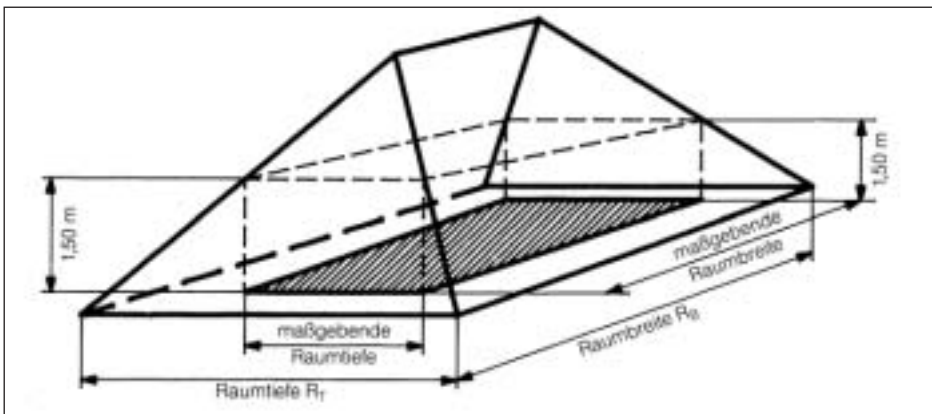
= Zur Berechnung der Fenstergröße maßgebende Raumgrundfläche (Nutzfläche)
